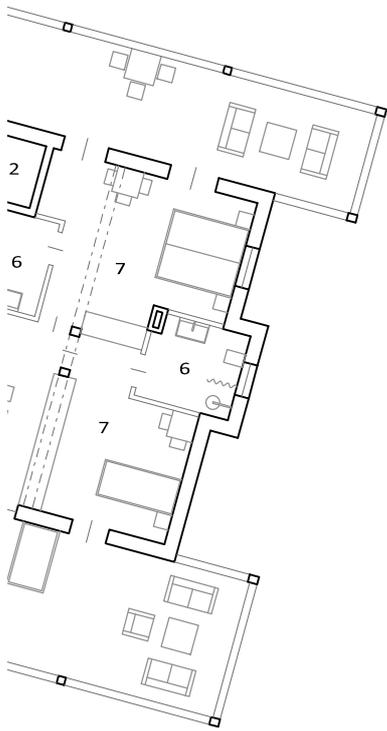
Grundriss Regelgeschoss 1:200
